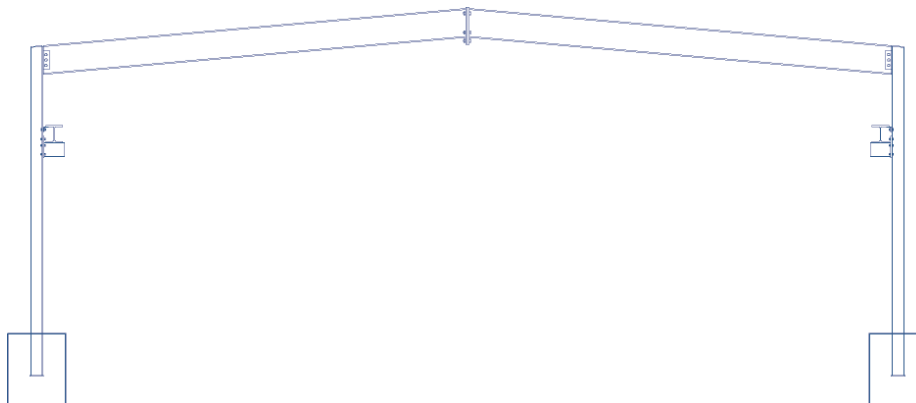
Typische Stahlhallenkonstruktion [6] mit eingespannten Stützen und gelenkig angeschlossenerm Binder: Spannweite 15 m, Traufhöhe 5 m und Dachneigung 5°
